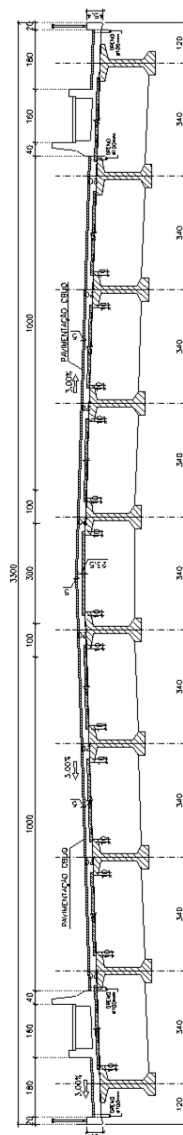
Perfil transversal da Ponte sobre o rio Poxim
